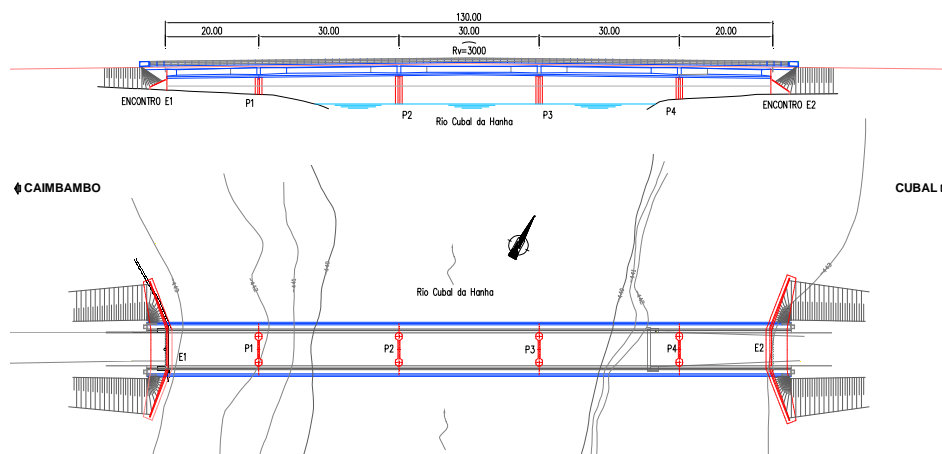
Alçado e Planta da Ponte sobre o rio Cubal da Hanha.
